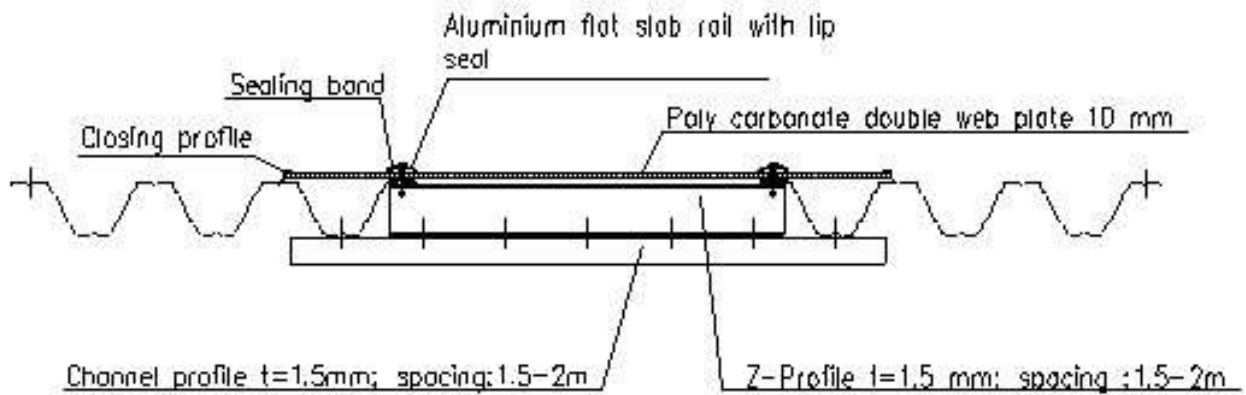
Стандартная крепёжная полоса для однослойной конструкции
